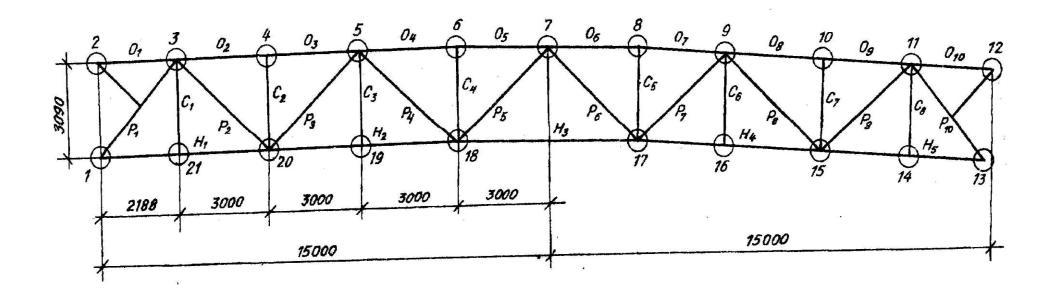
Геометрическая схема фермы Φ C 30 – 1,5 0B; 1,50 D1
